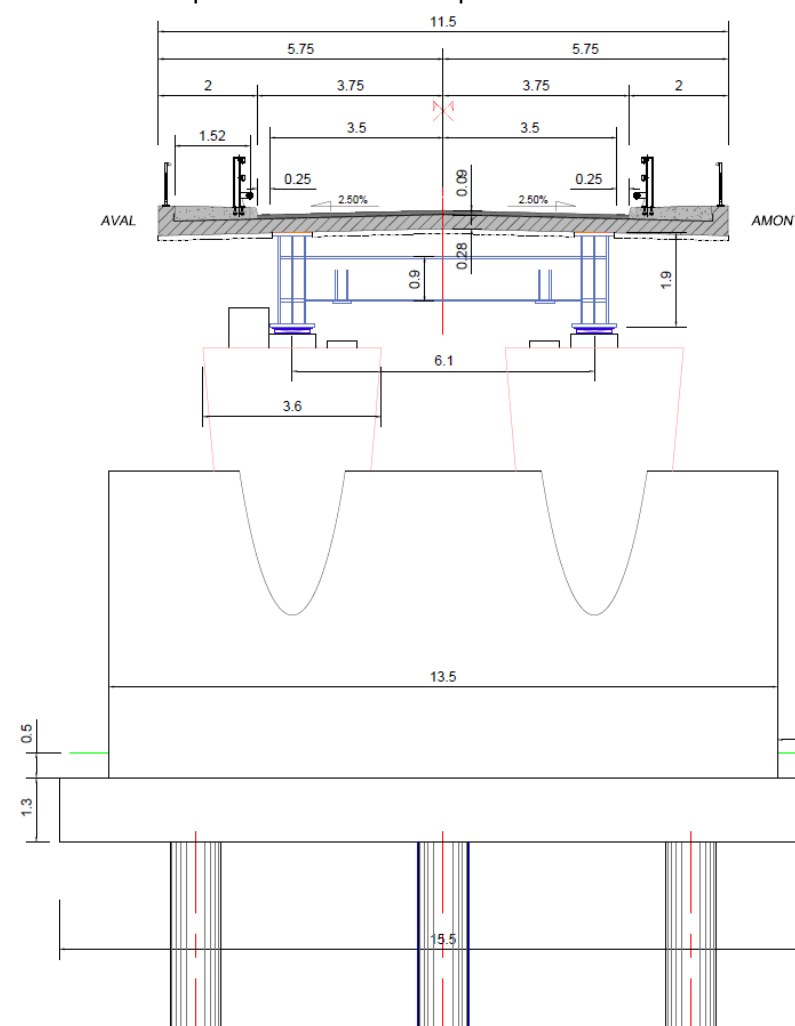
Coupe transversale d'une pile du futur ouvrage d'art (source : APD, additif, Infratech)
